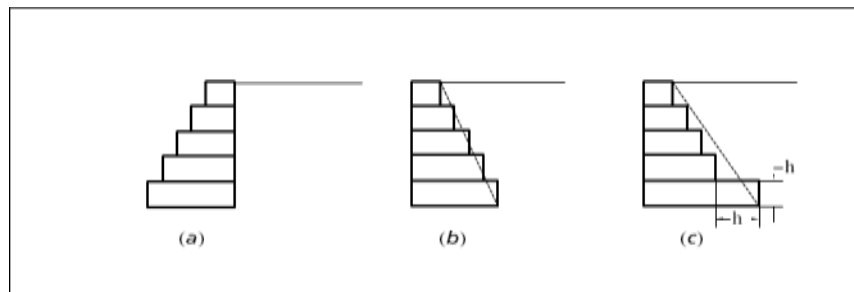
Plano de aplicación del empuje activo Tipo de gaviones
